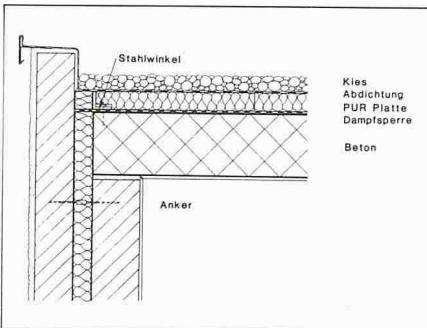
Auf der Betondecke fixierter Stahlwinkel zur Ableitung der Druckkräfte
